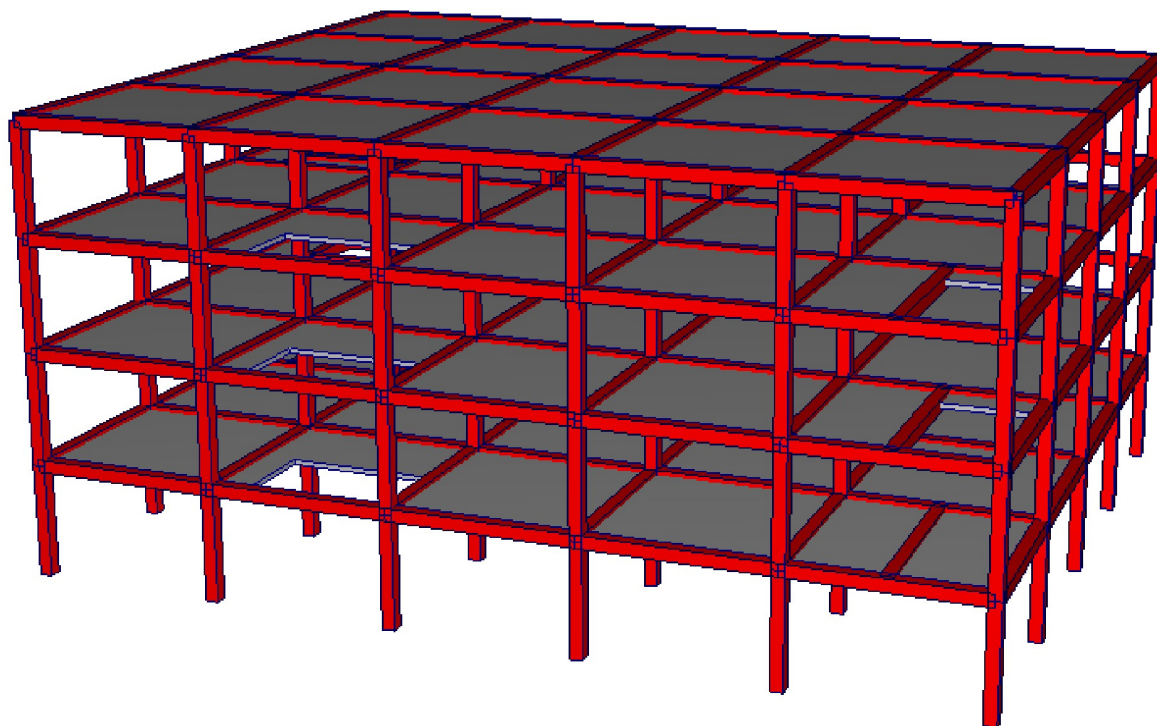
Розрахункова схема будівлі (ПК FORUM)
